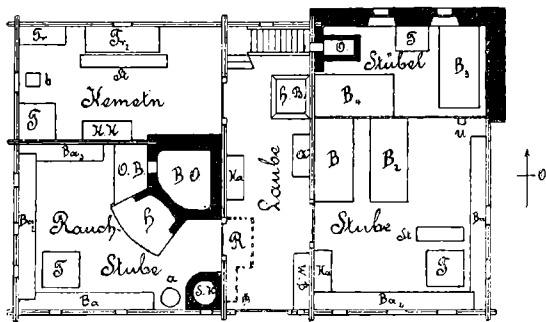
Grundriss des Erdgeschosses der Rader-Keusche.
